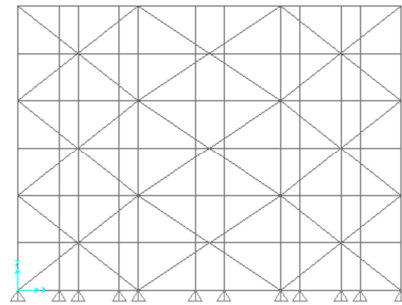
Configuração dos Planos de Contraventamento Vertical Com Elementos de Contraventamento Grandes
